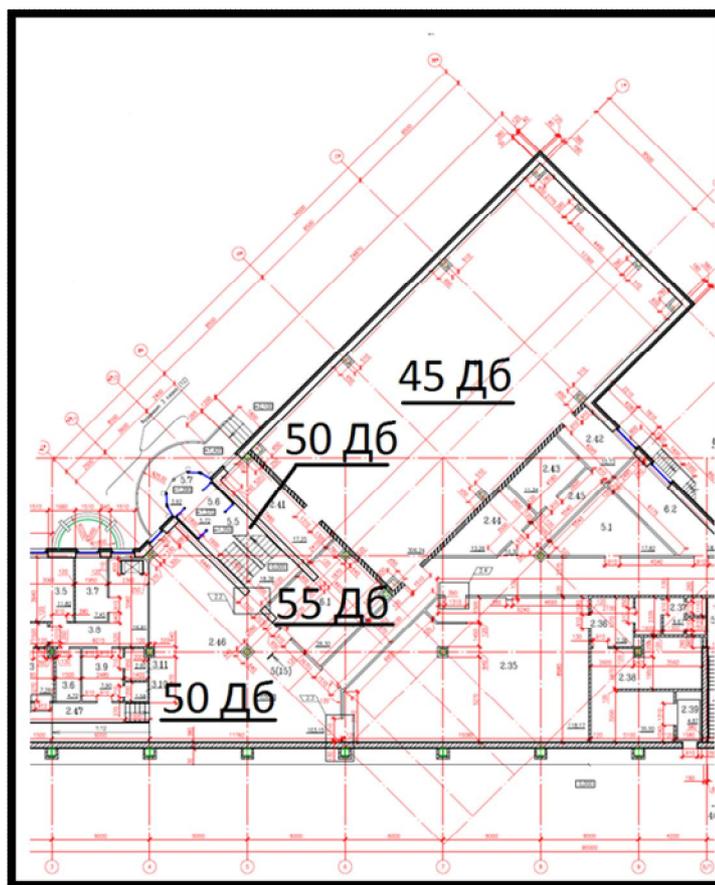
Фрагмент плана 1-го этажа здания спортивного комплекса с плавательным бассейном
